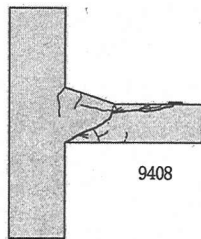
TYPE-III①試験体 (ハッチ始点が載荷点より下のひび割れ発生状況
